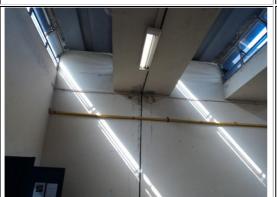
Trincas na parede e queda de parte Foto 04 – Trincas e queda de parte do do reboco do teto da UAN
